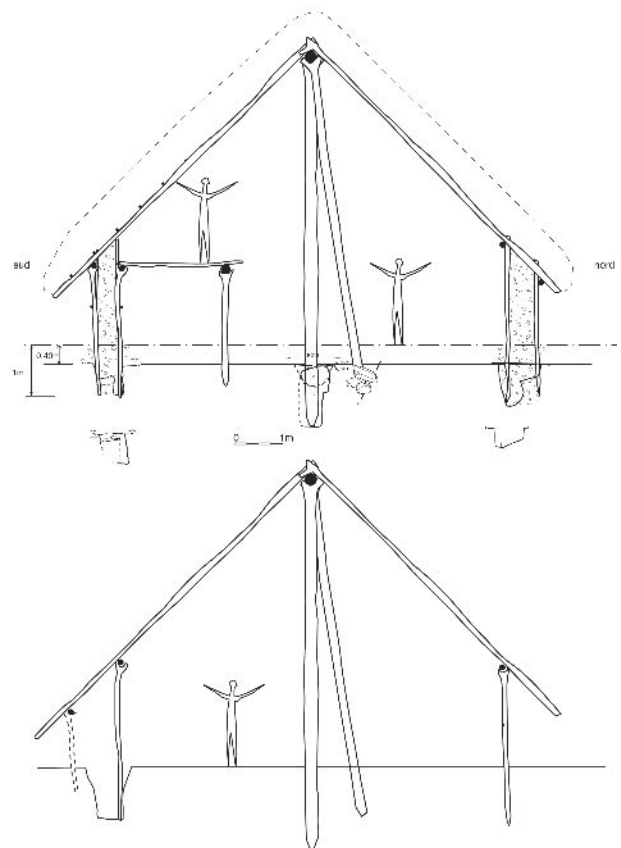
Beaumont, Champ Madame, coupe transversale (DAO, Ch. Le-Barrier).
